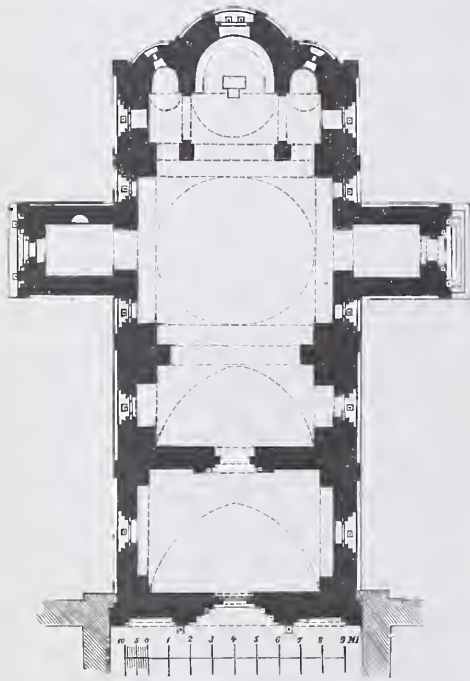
Kirche zu Studenica. Grundriss.
